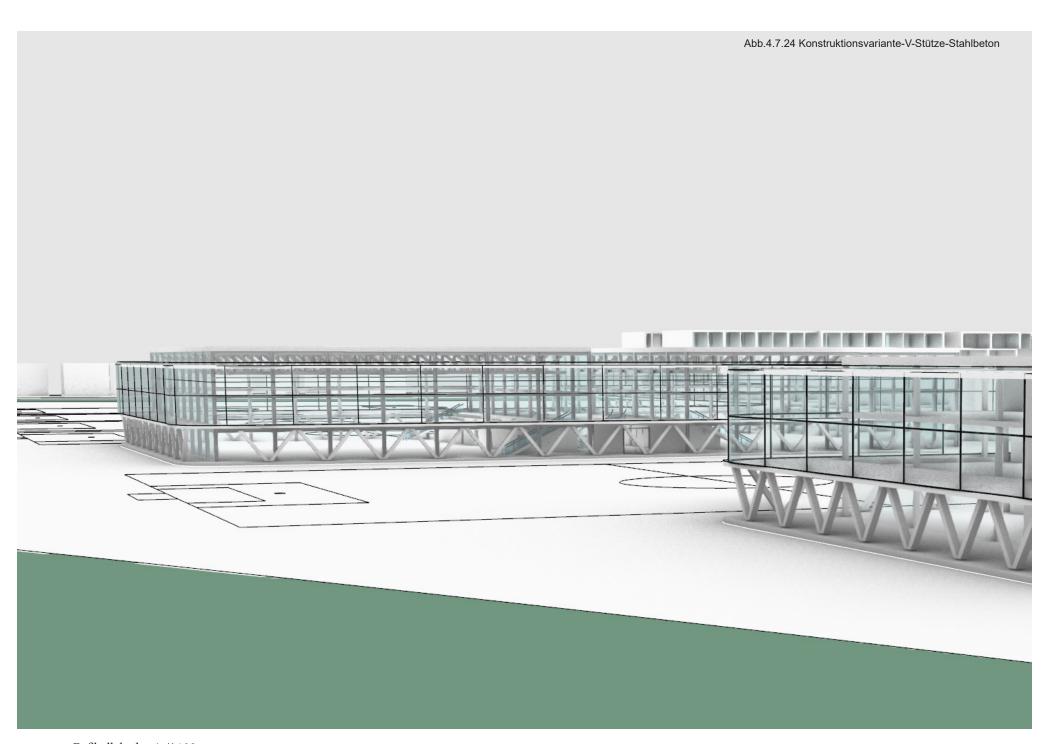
Konstruktionsvariante-V-Stütze-Stahlbeton
